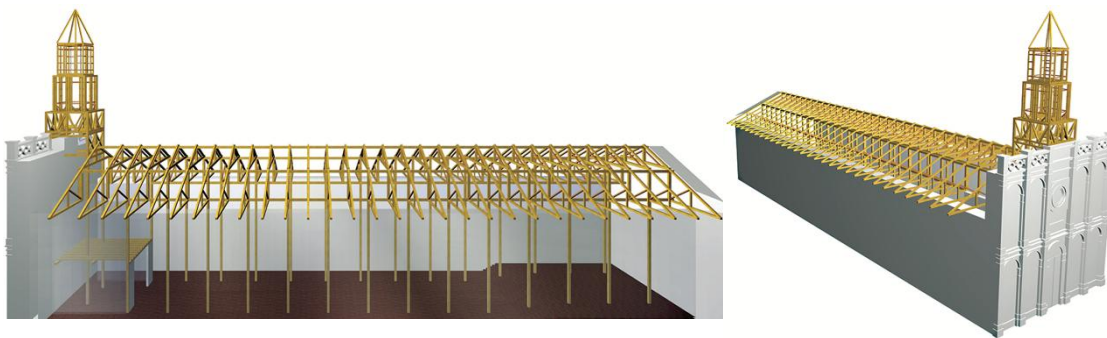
Estructura de madera en cubierta y torre de la iglesia.
